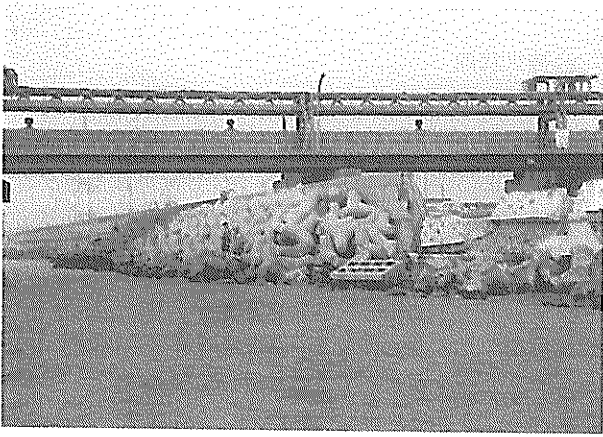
小野田地区西沖護岸 棧橋周囲の状況
